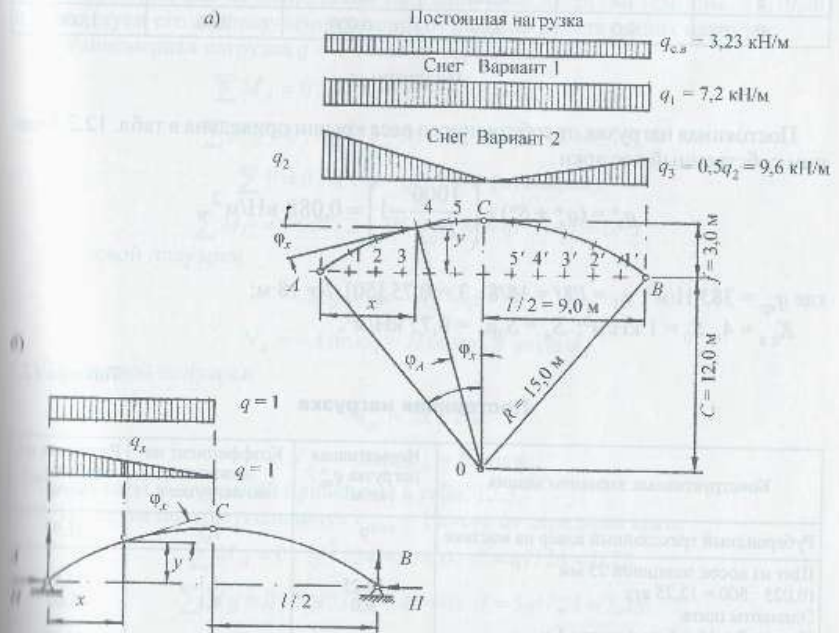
К расчету круговой арки: а – расчетная схема и виды нагрузок; б – единичные нагрузки на арку
